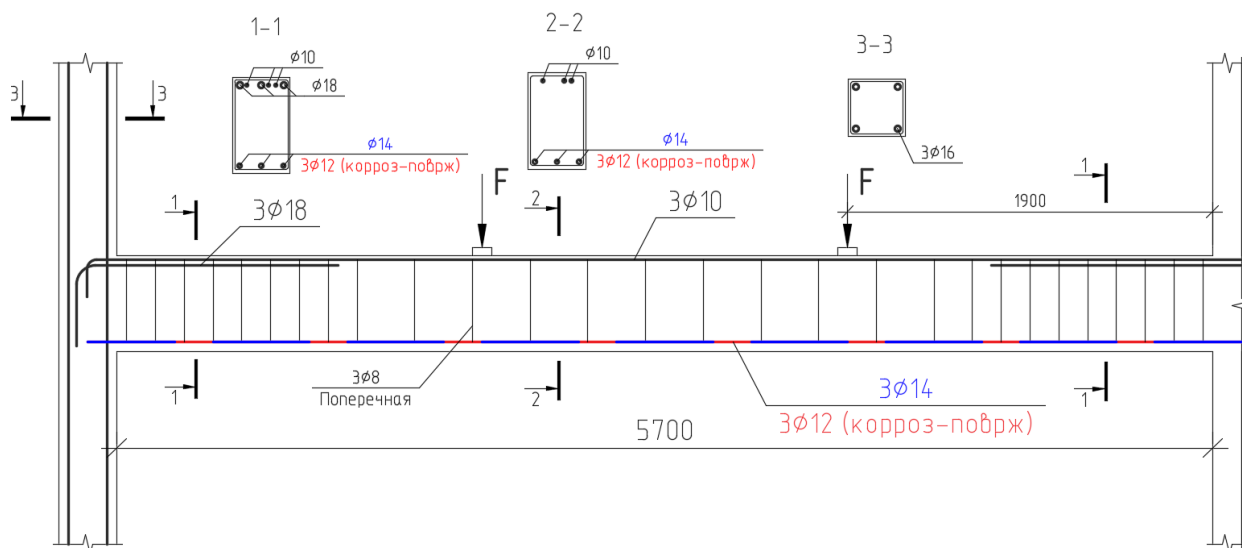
Схема армирования двухпролетной балки (показана 1/2 балки)
